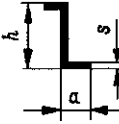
Простановка размеров на проектных чертежах металлоконструкций
